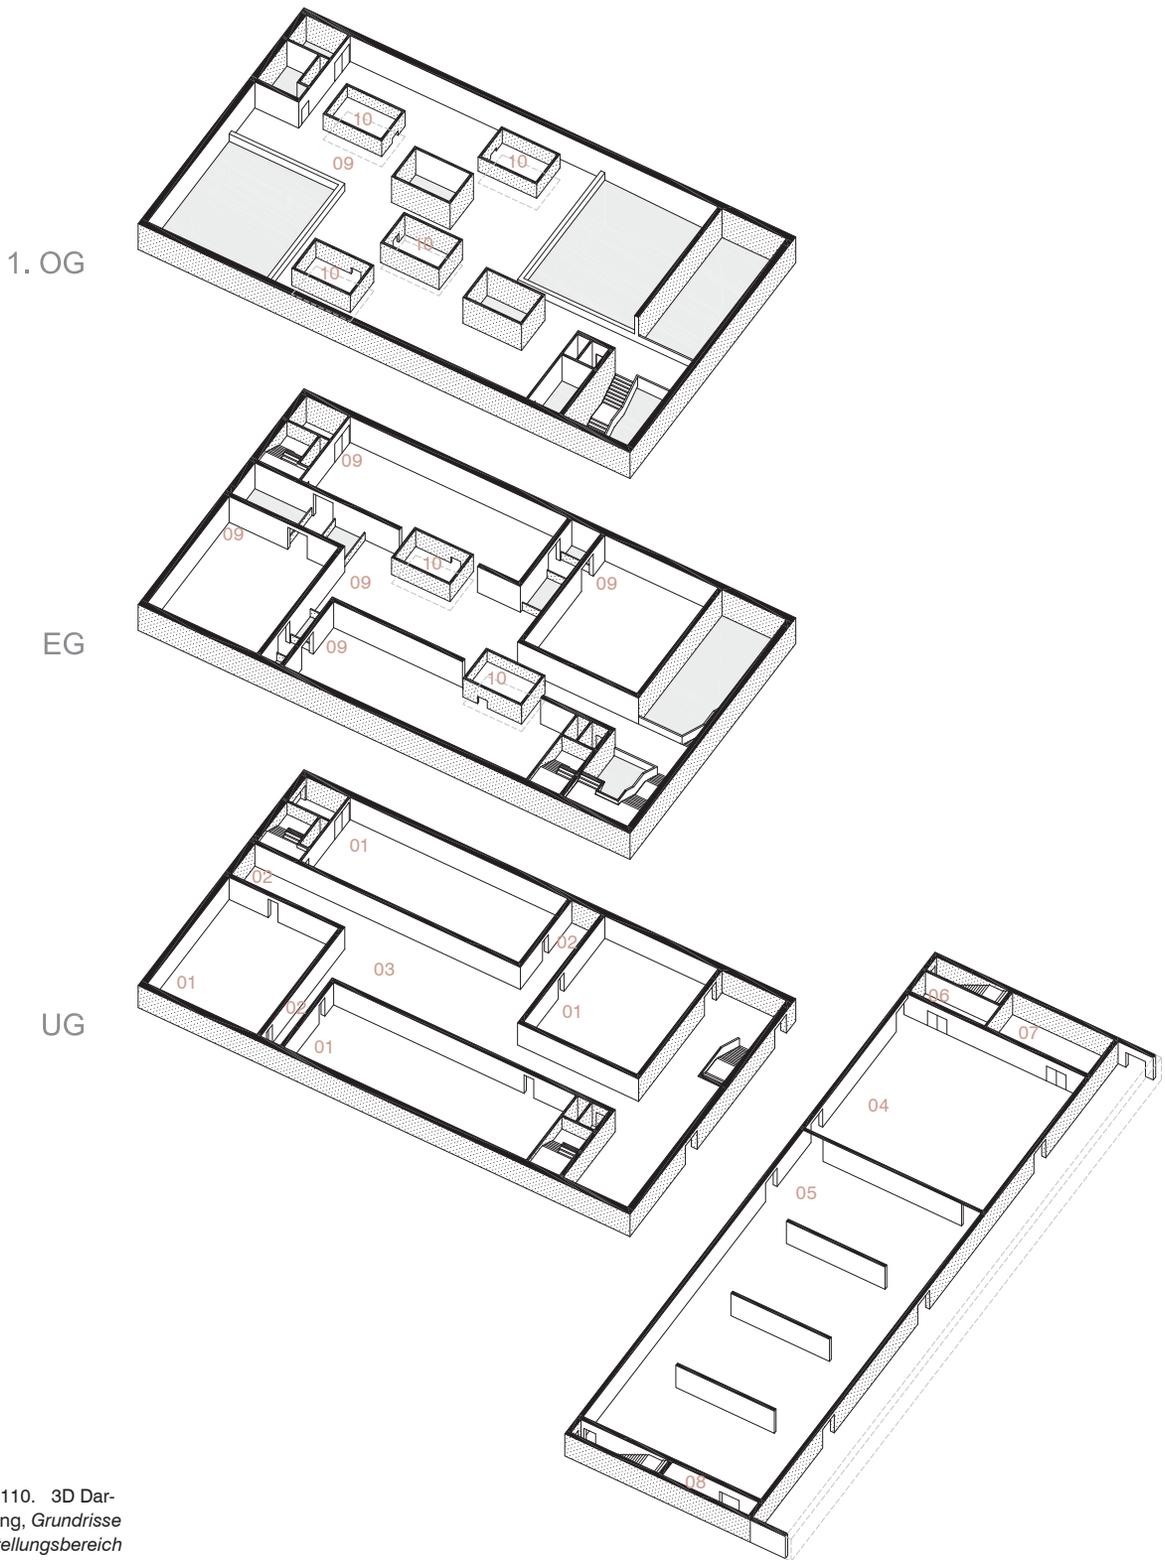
3D Darstellung, Grundrisse Ausstellungsbereich
